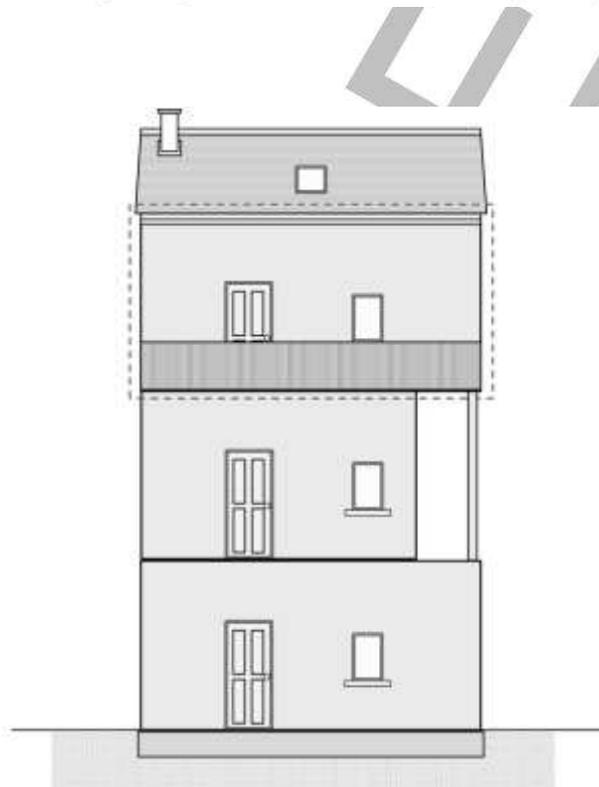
exemple de l'avancée de plancher supérieur soutenu par un poteau (proscrite)
